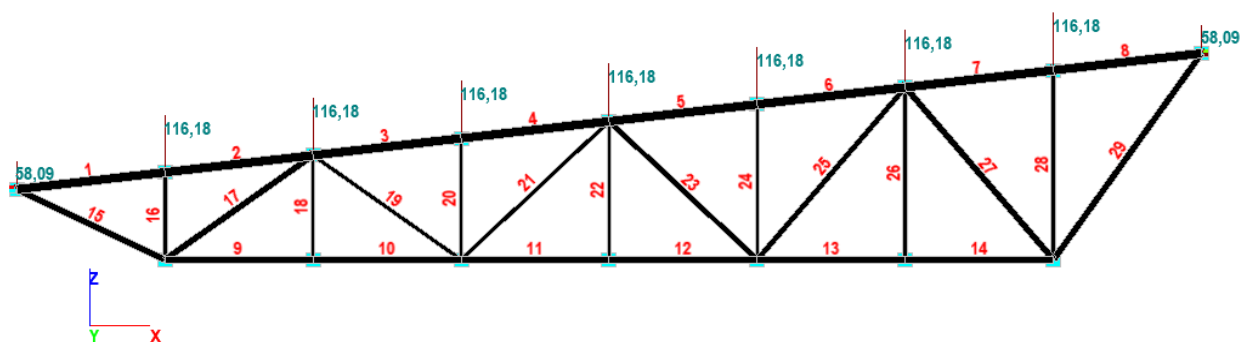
Загрузка №1 расчетной сосредоточенной нагрузкой фермы без учета собственного веса, кН
